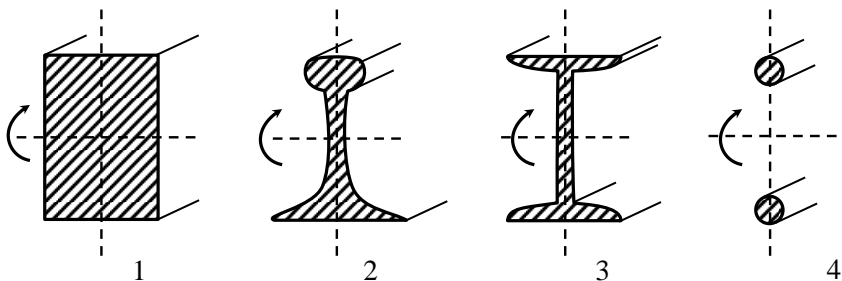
Сечения: 1 – прямоугольное, 2 – рельс, 3 – двутавр, 4 – плоская ферма из стержней круглого сечения
